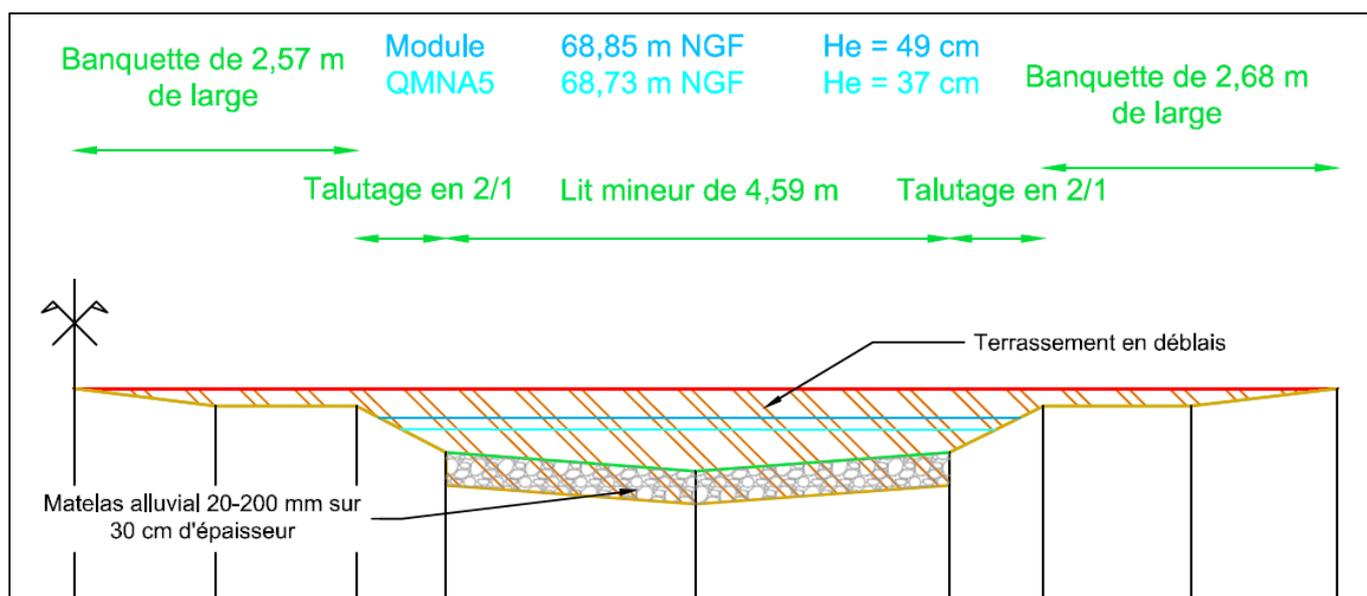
Profil en travers type au droit d'un radier (PT4)
